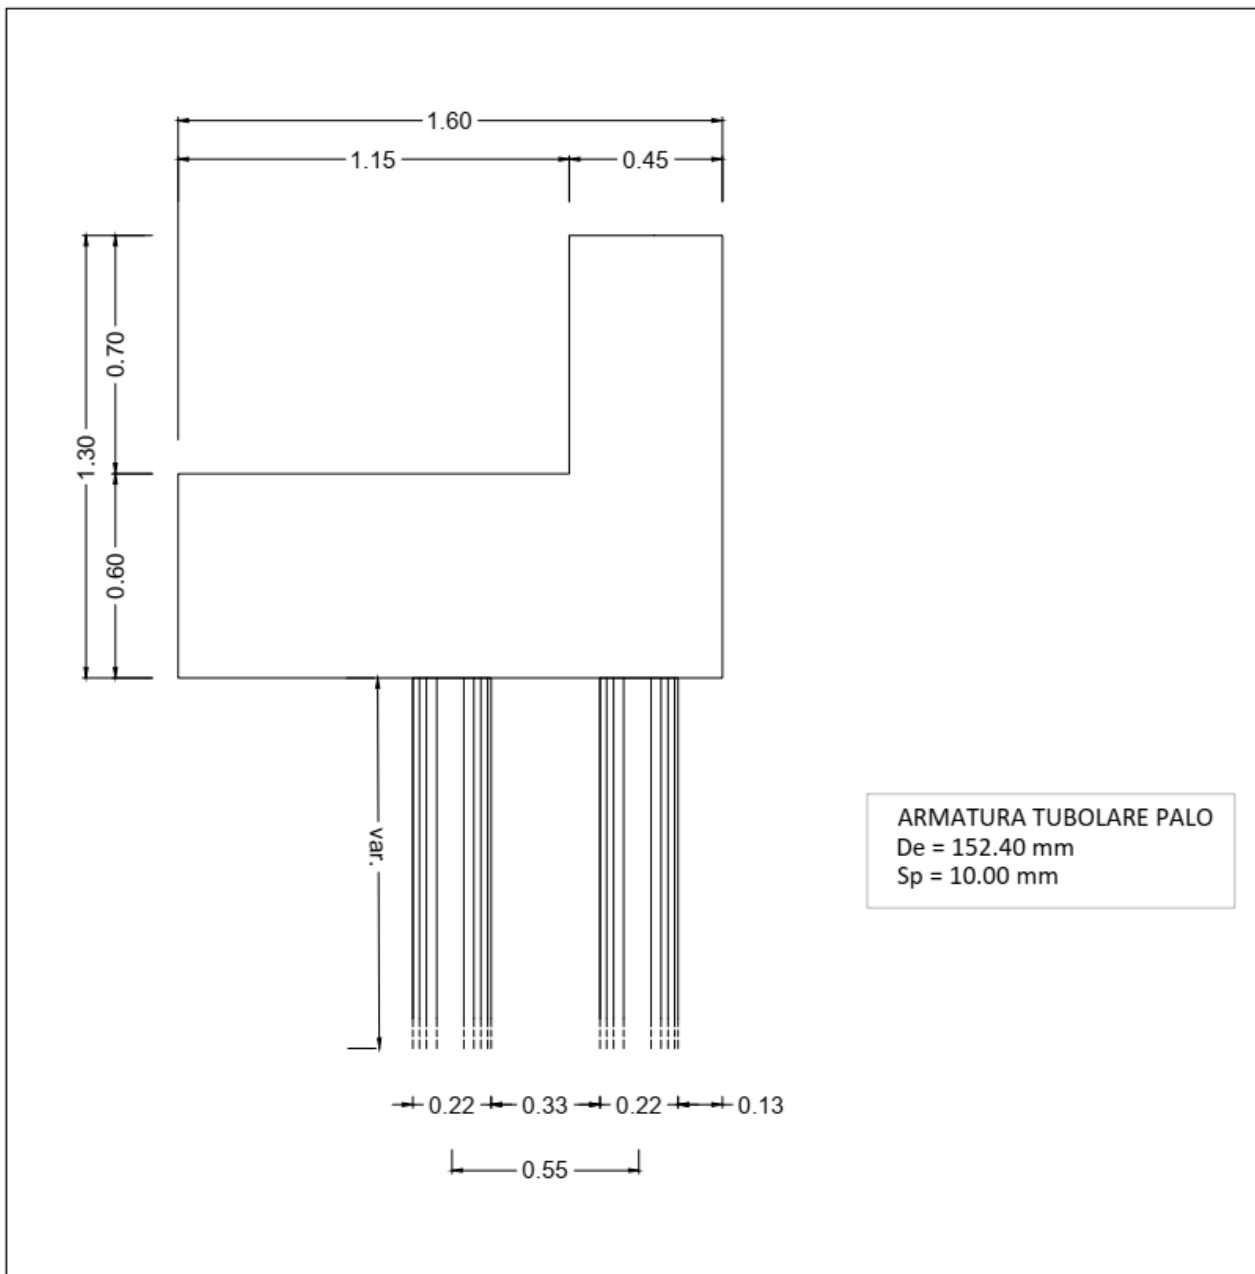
DETTAGLIO MURO PARAGHIAIA E SPALLETTE
